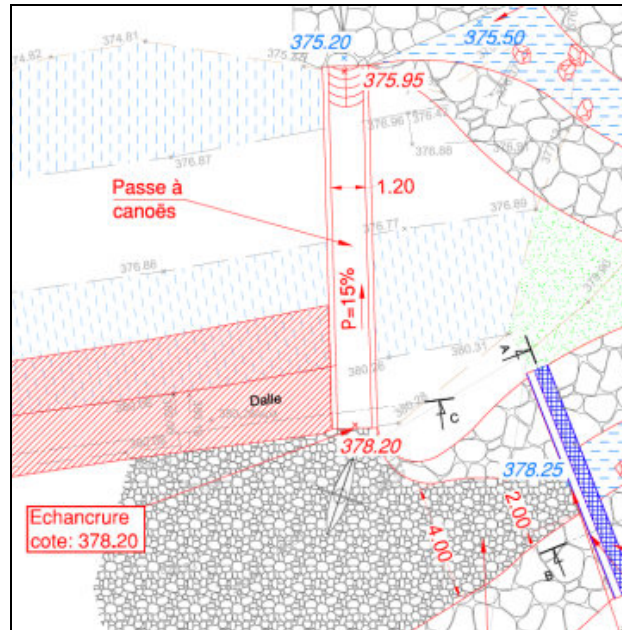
Vue en plan de la passe à canoë et de sa position par rapport à la rivière de contournement
